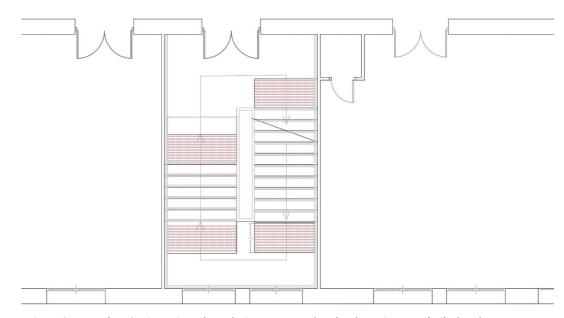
Escalera 3, Itinerario 4 Planta baja, propuesta, bandas de pavimento táctil y bandas antideslizantes.
